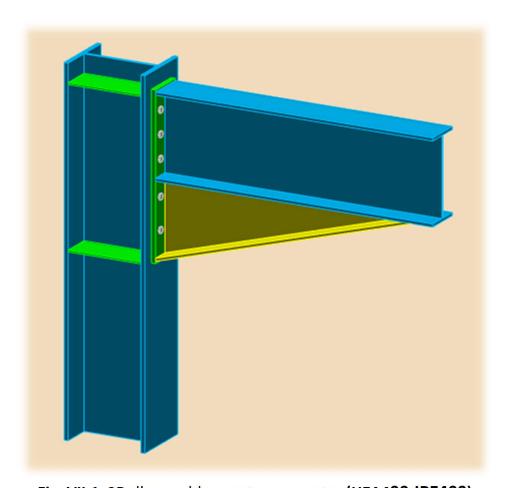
3D d'assemblage poteau - poutre (HEA400-IPE400)
